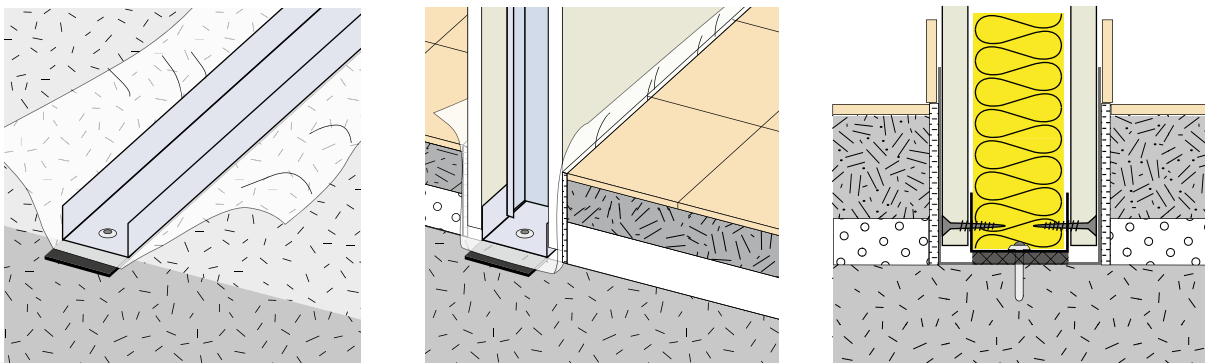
Aplicação de película de polietileno, entre a laje de betão e o perfil raia, e de tiras de material flexível, para separação da divisória do enchimento da laje.
